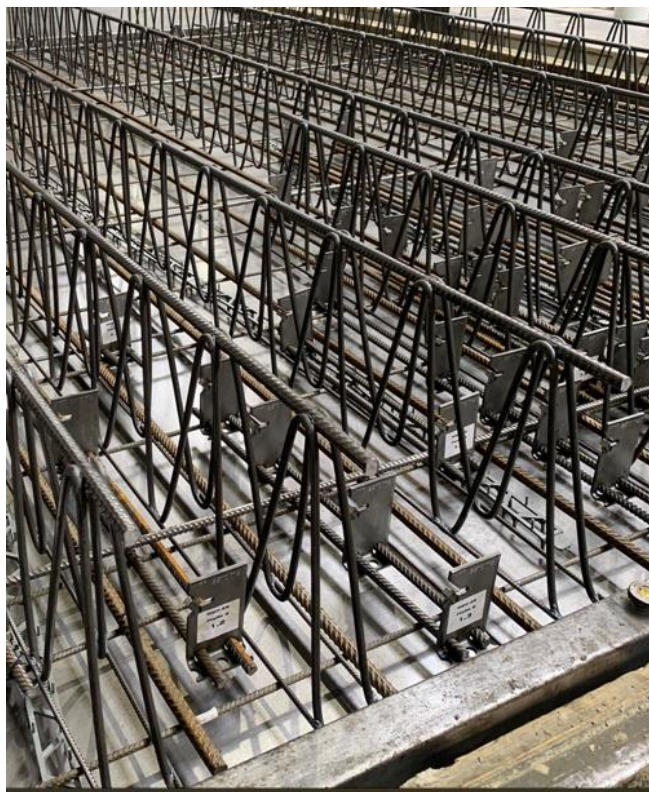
Kollisionsfreie Bewehrungen für eine Decke mit großer Höhe
